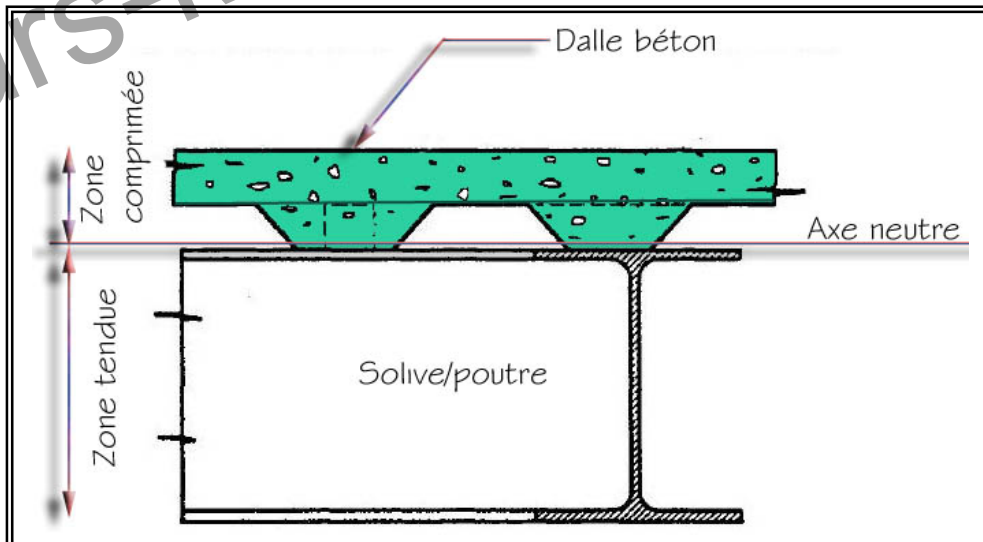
Principe de fonctionnement d'une dalle mixte acier - béton.
